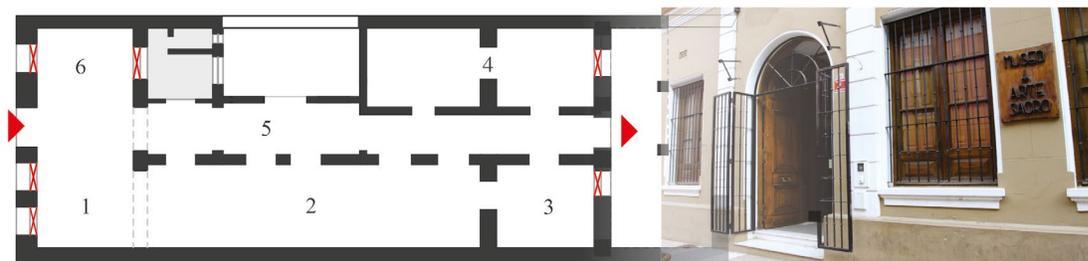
Planta y fachada del Museo de Arte Sacro de Tucumán (Planimetría: Bazán y Ajmat, 2021; fotografía: Juan Ajmat, 2018).
